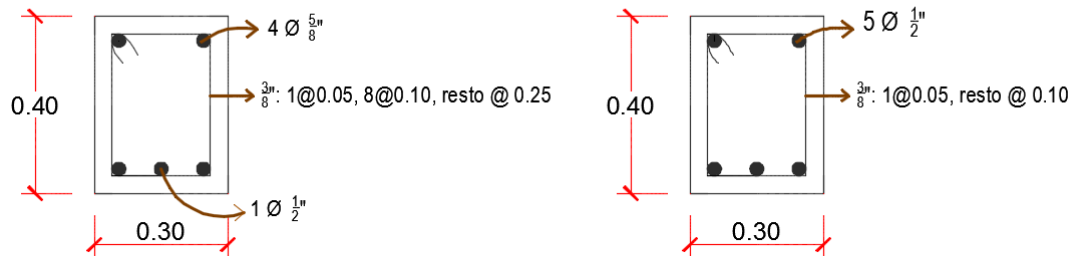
Distribución de acero en vigas de cimentación – viga de cimentación transversal
